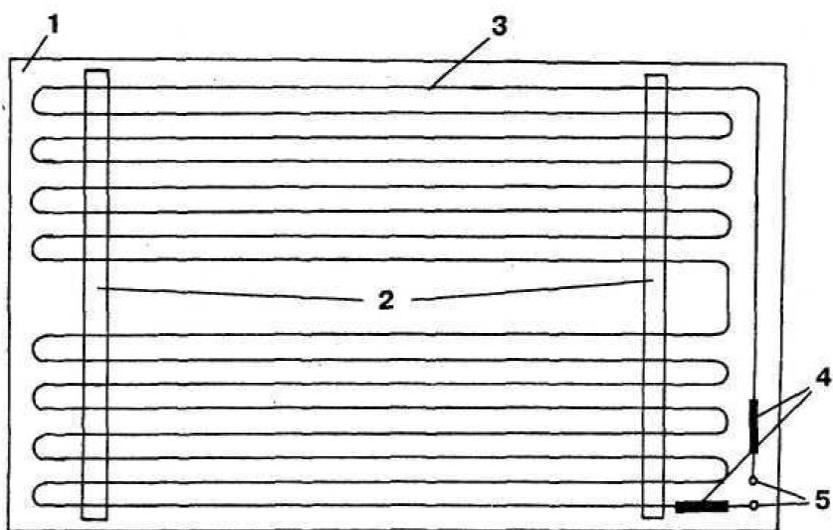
Схема укладання нагрівального дроту для обігріву ґрунту :
